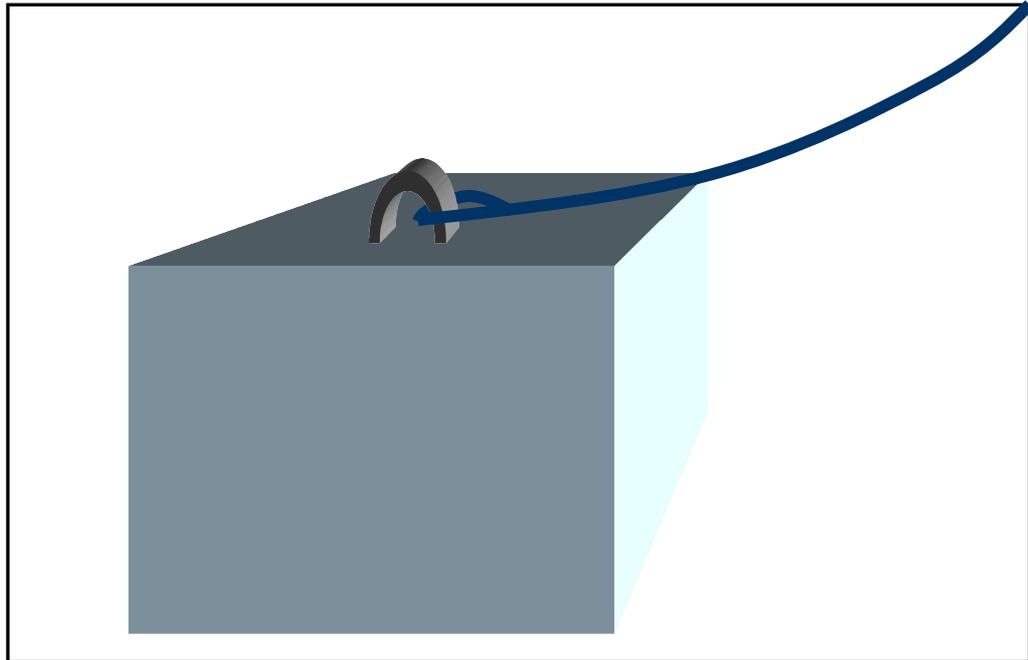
; Muertos de Anclaje de concreto armado de 1000 kg aproximadamente.
